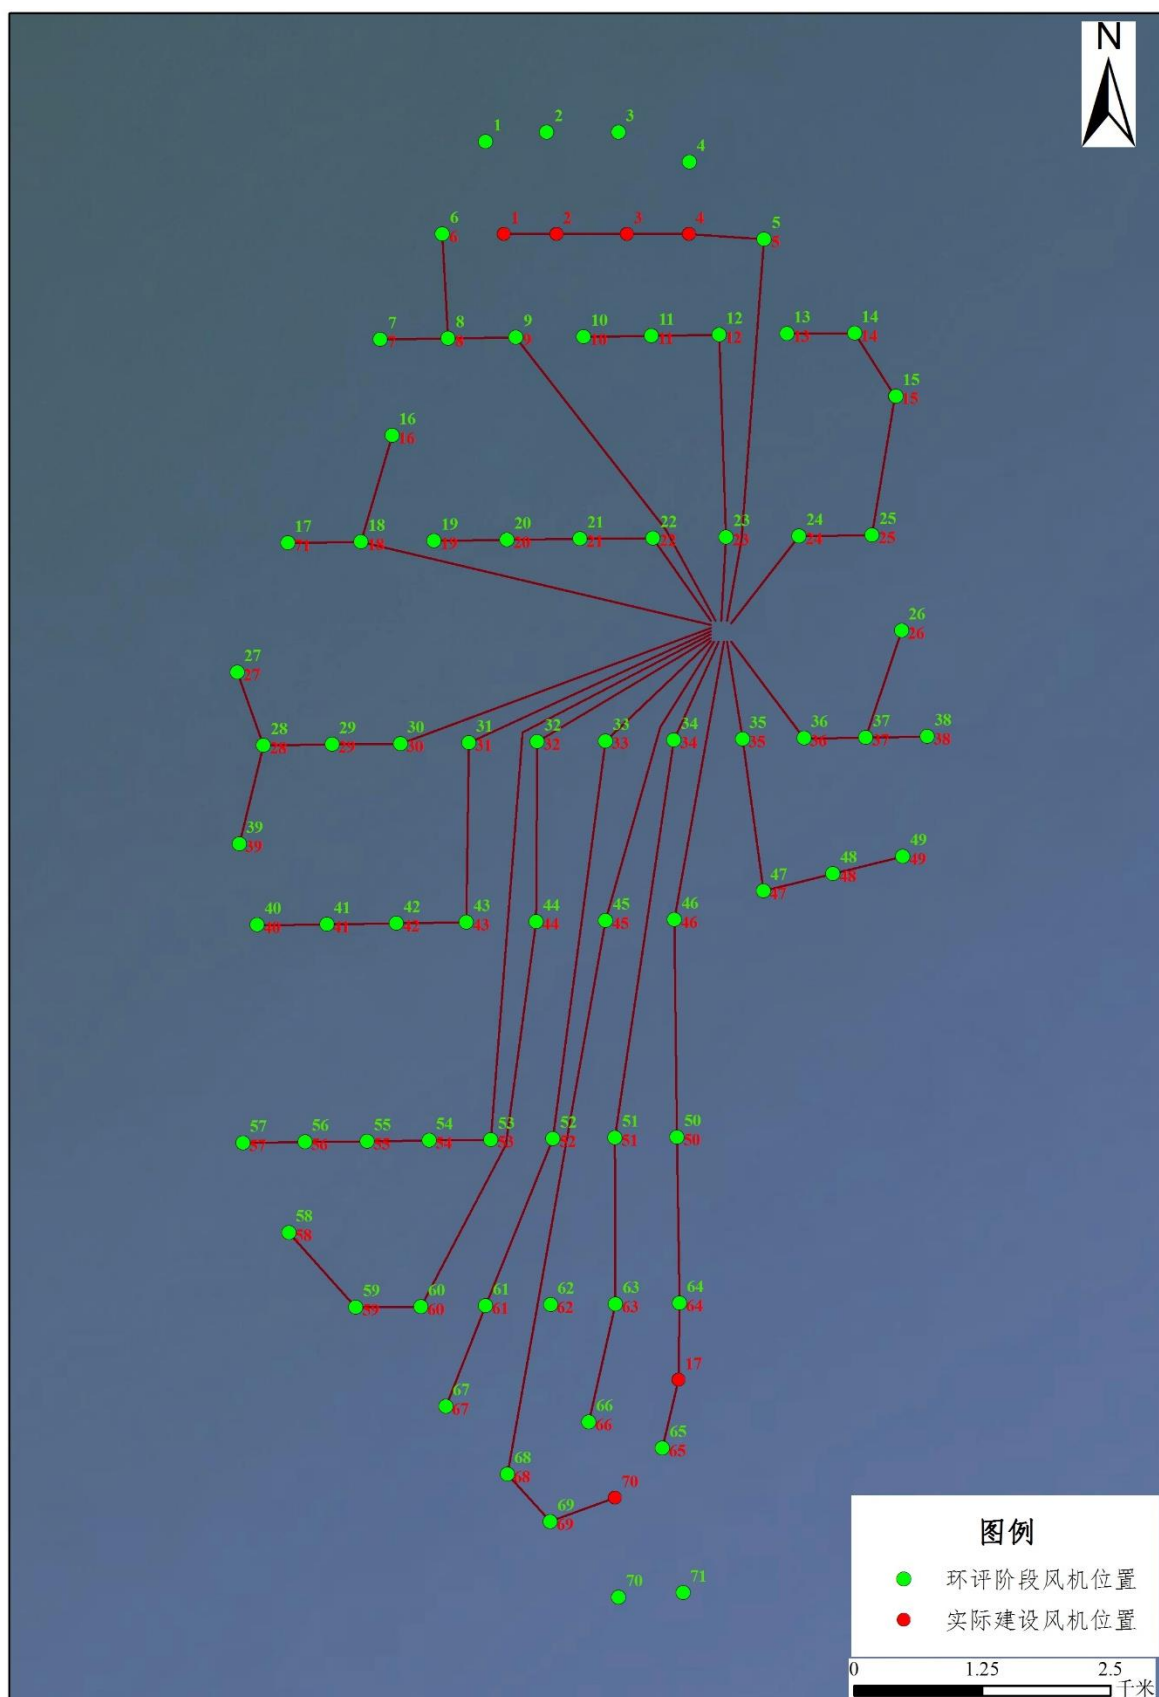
本项目风电机组及 35kV 海缆平面布置图
